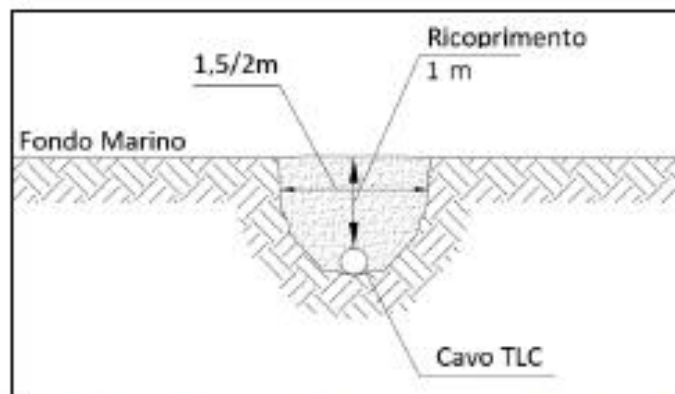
Tipica Sezione Trasversale di Cavo affossato
